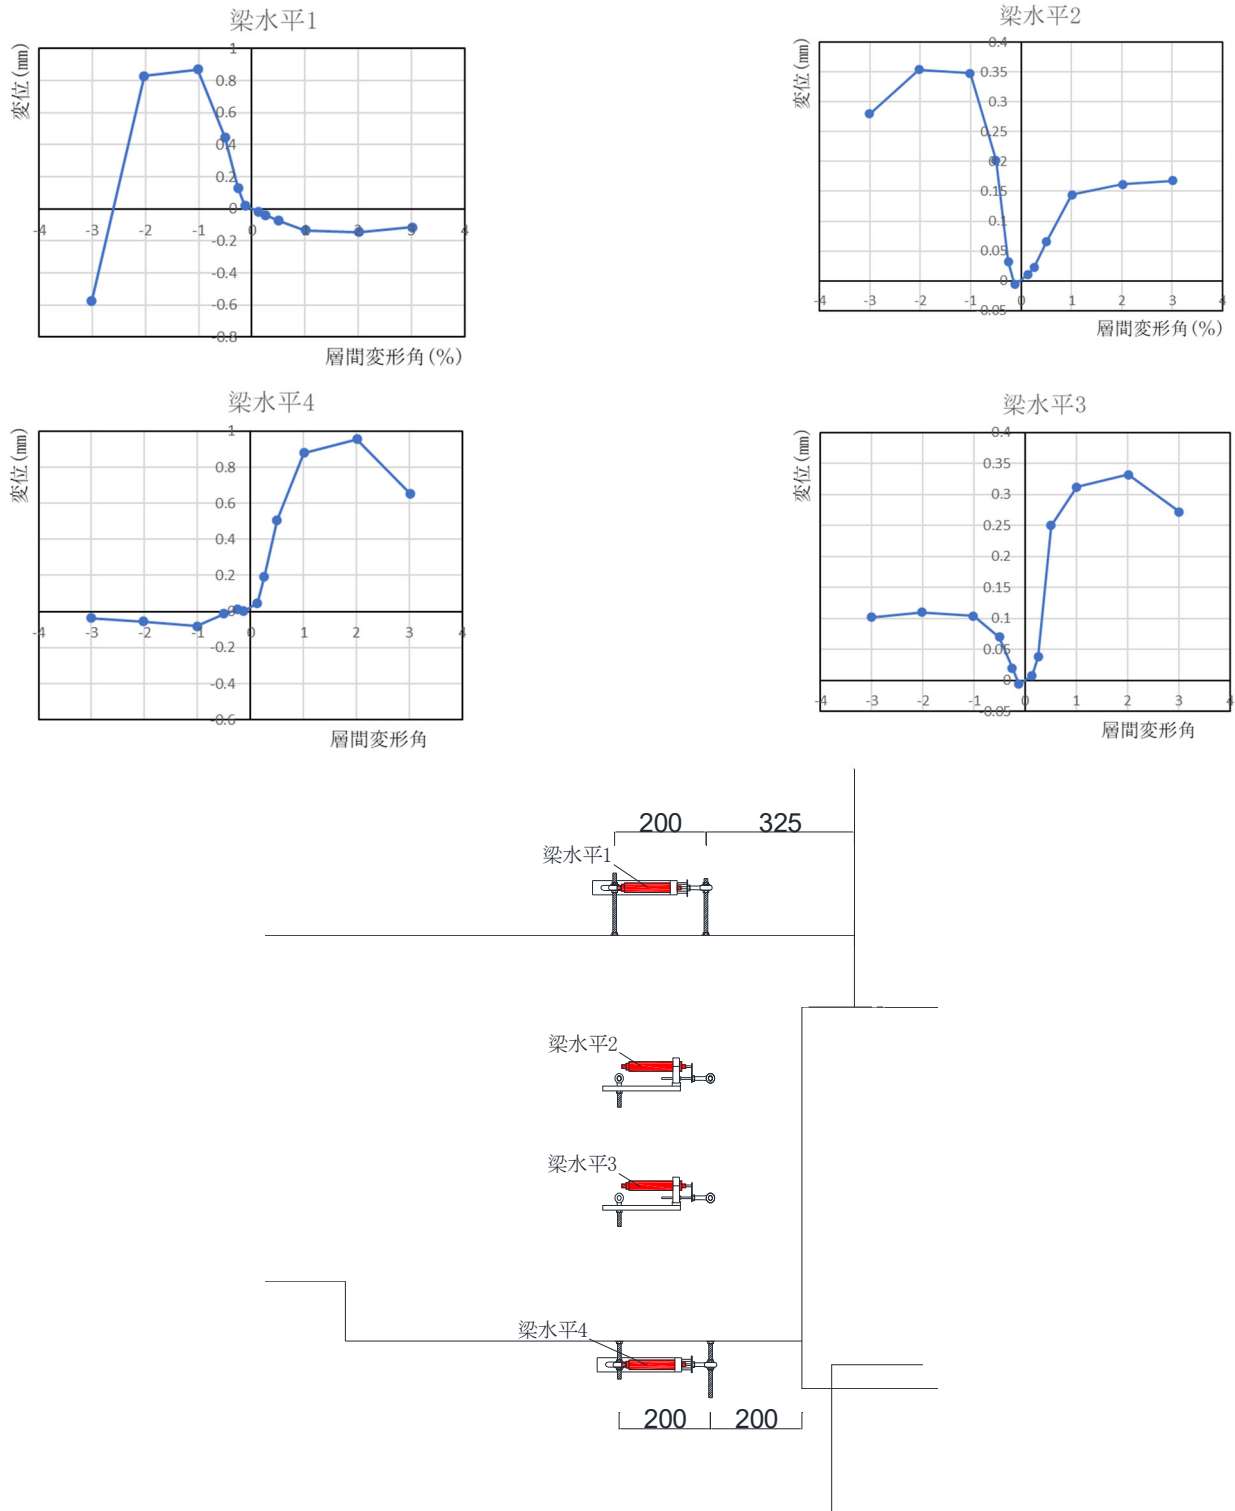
試験体 E-2 基礎梁変位 変形-層間変形角関係 1
